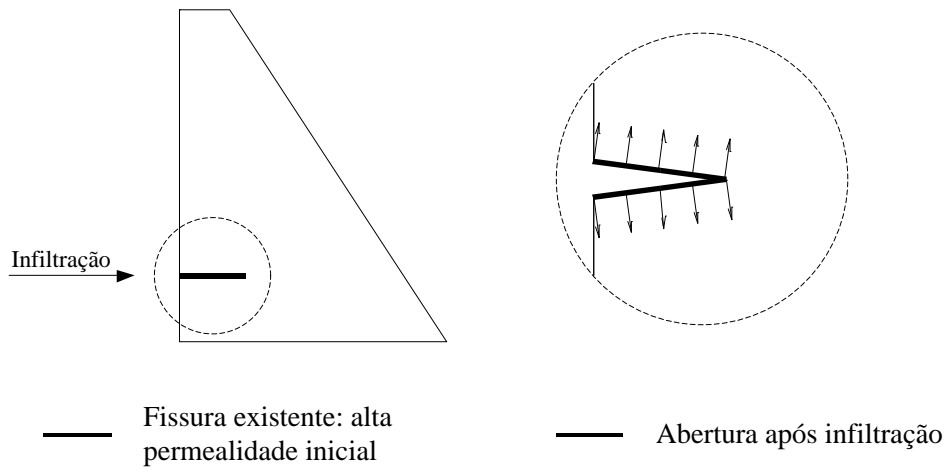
Fase 1: Fissura e infiltração
